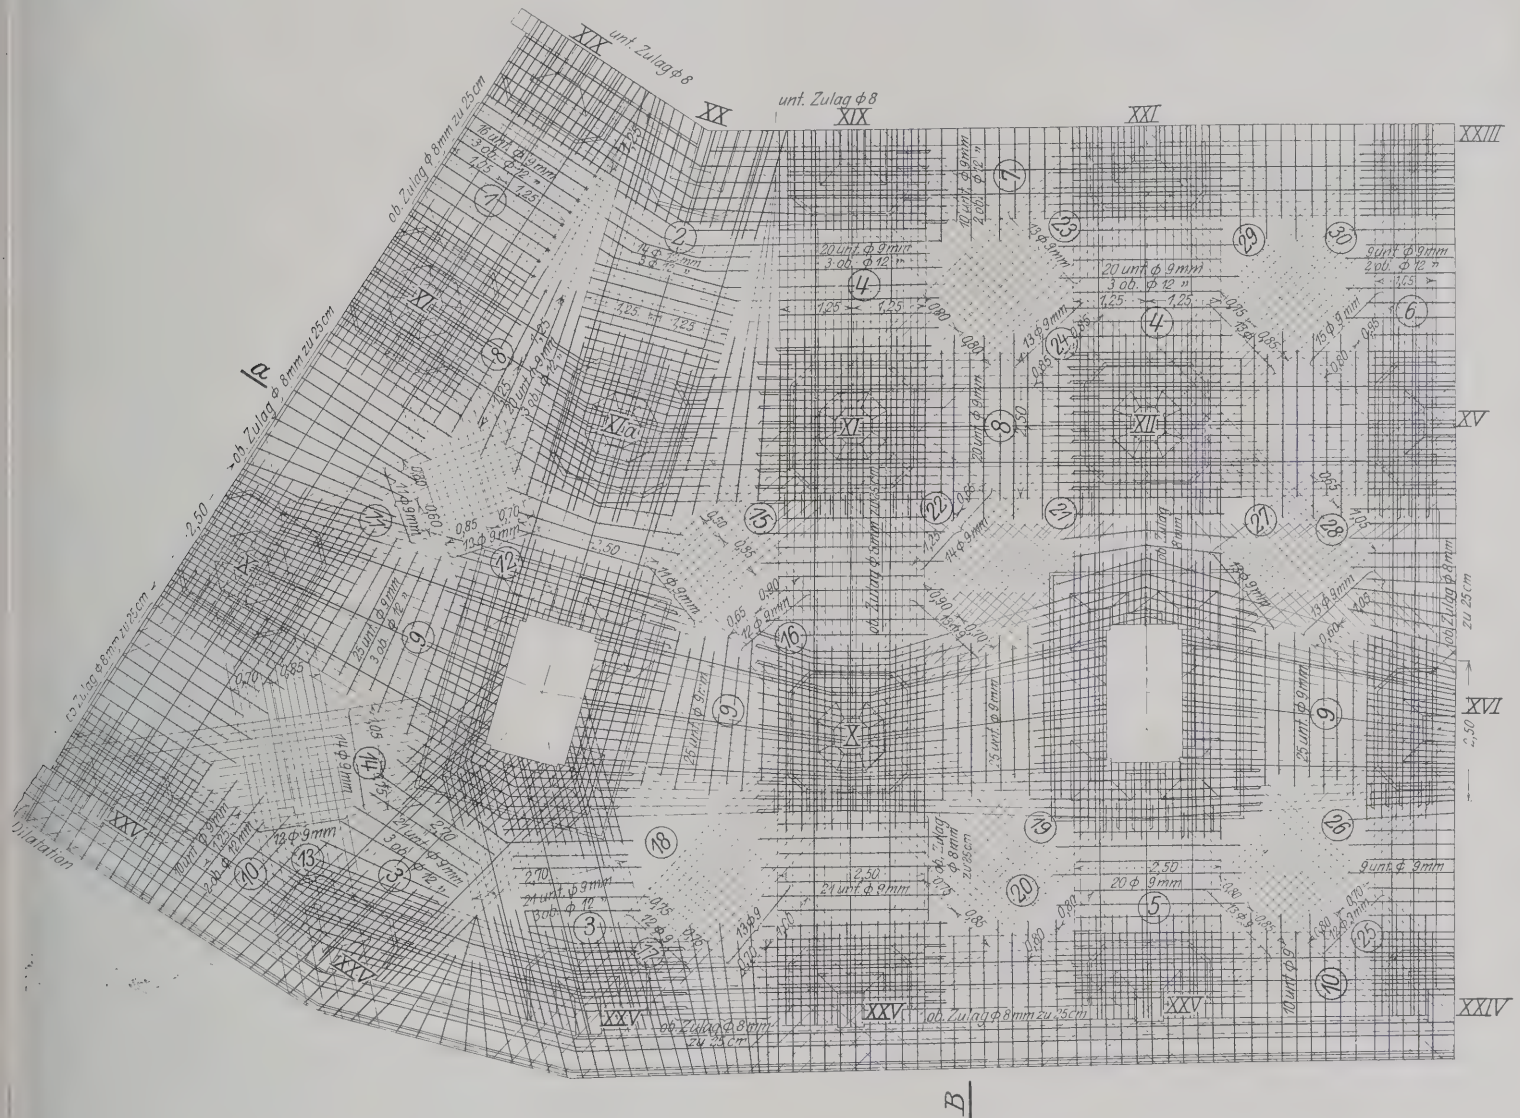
Armierungsplan der Pilzdecke, oberstes Stockwerk, I. Teil.
